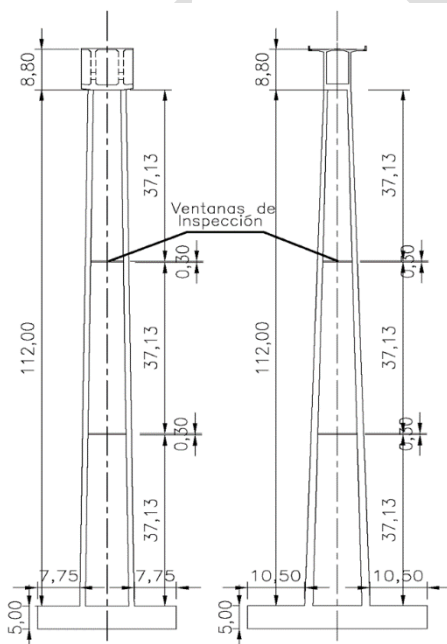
Sección pilas (transversal lado izquierdo, longitudinal lado derecho). Fuente: Autores.
